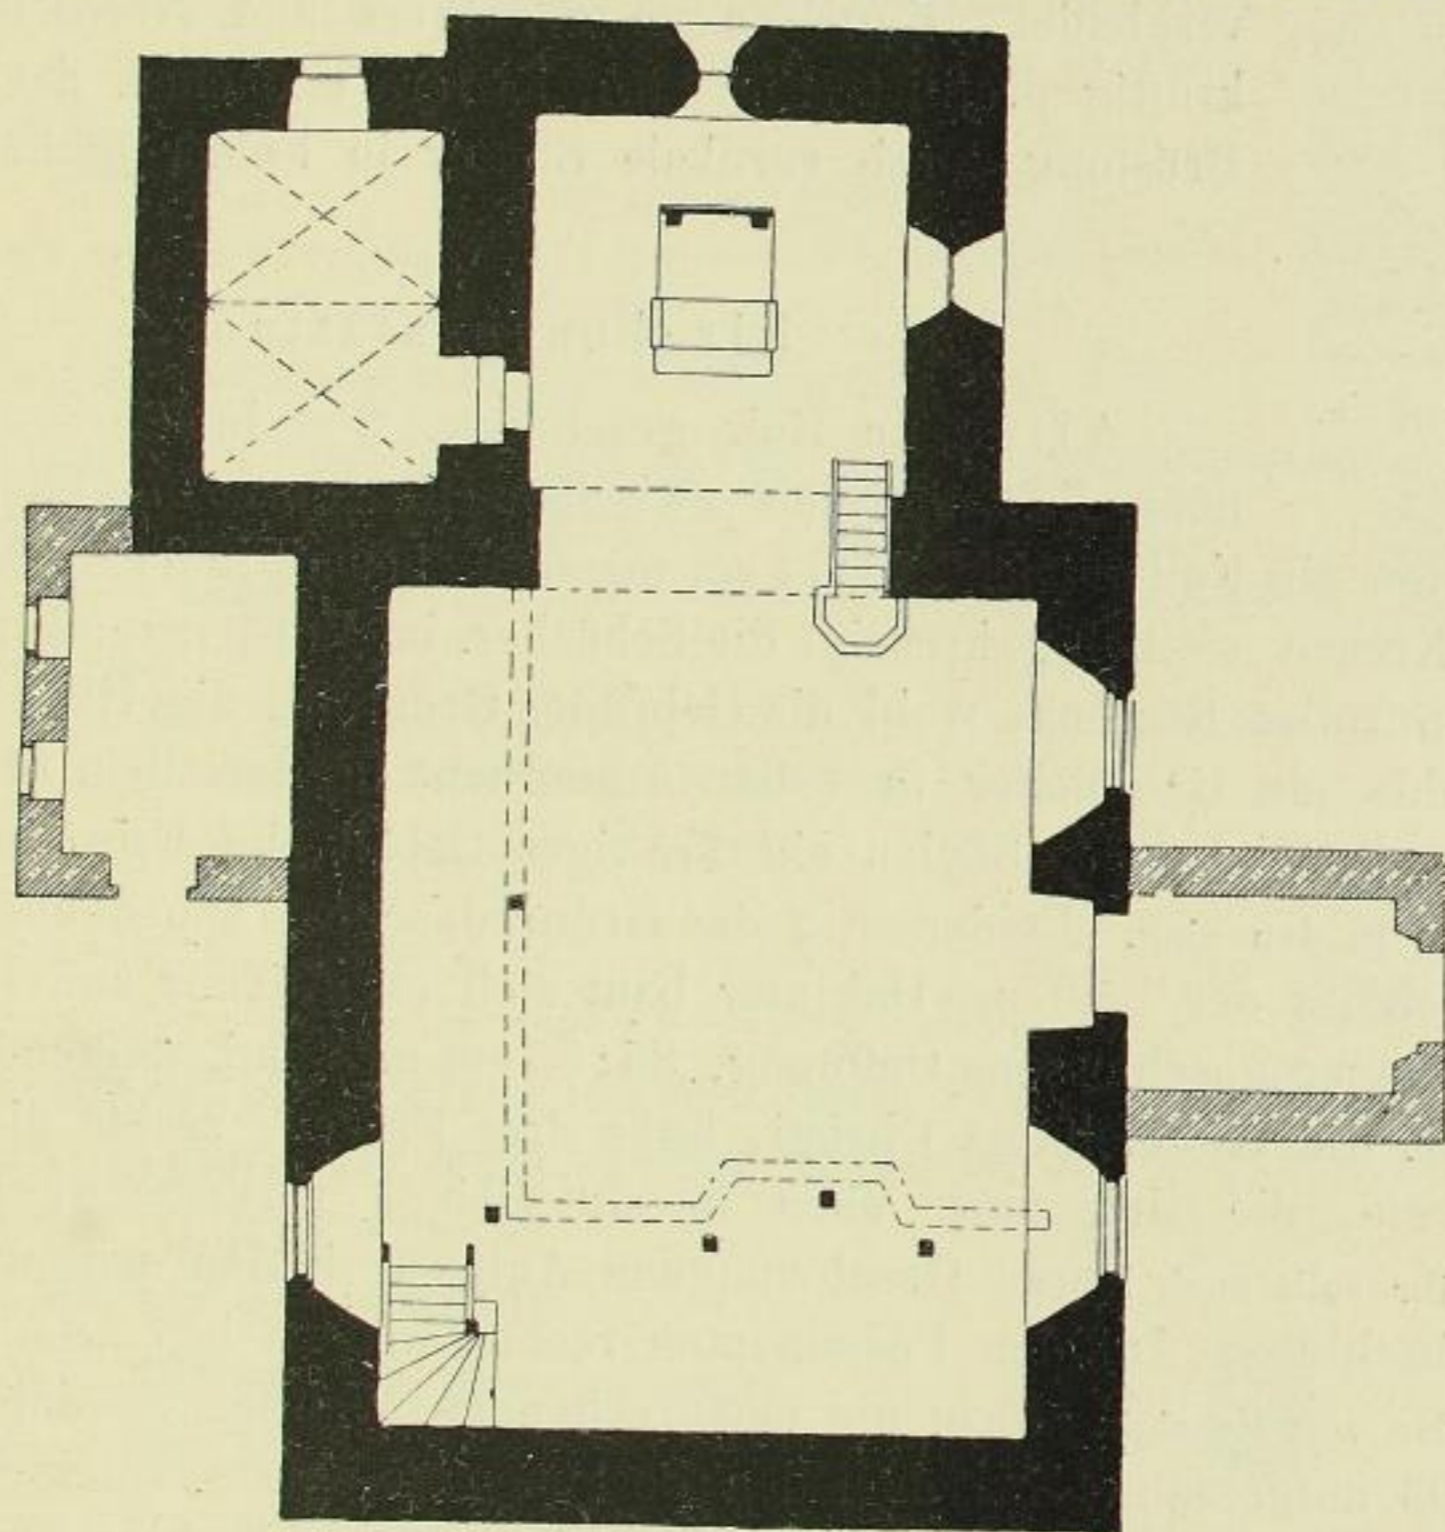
Schönborn, Grundriss der Kirche.
